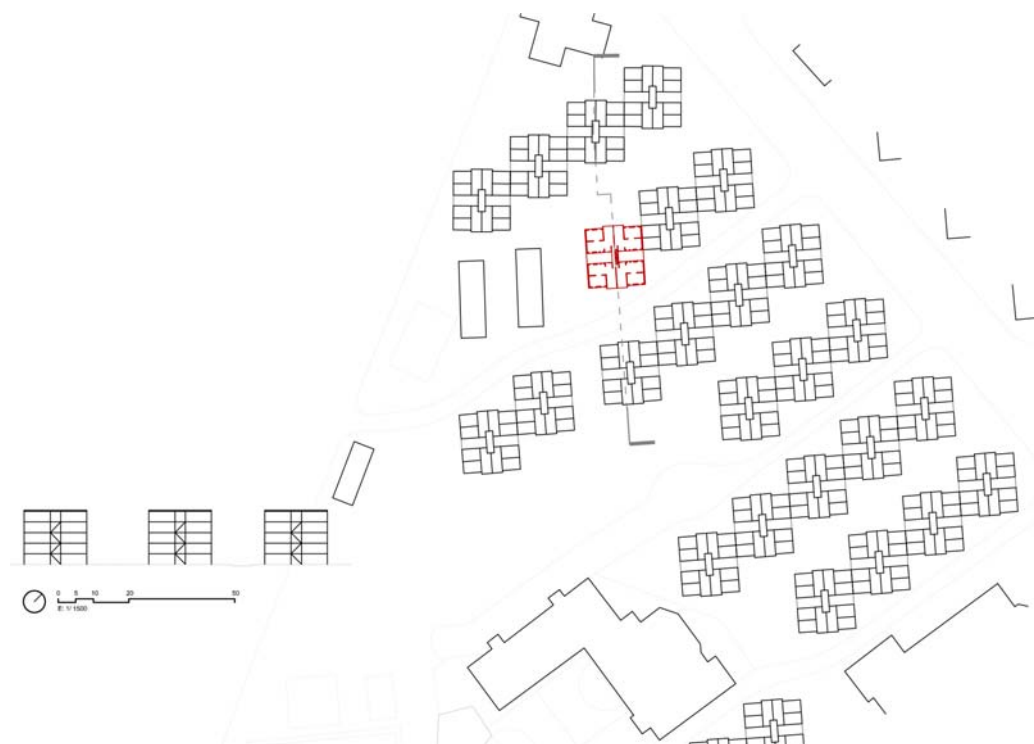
Plànol d'emplaçament i descripció tipològica en planta i secció d'un sector. Sant Roc.
